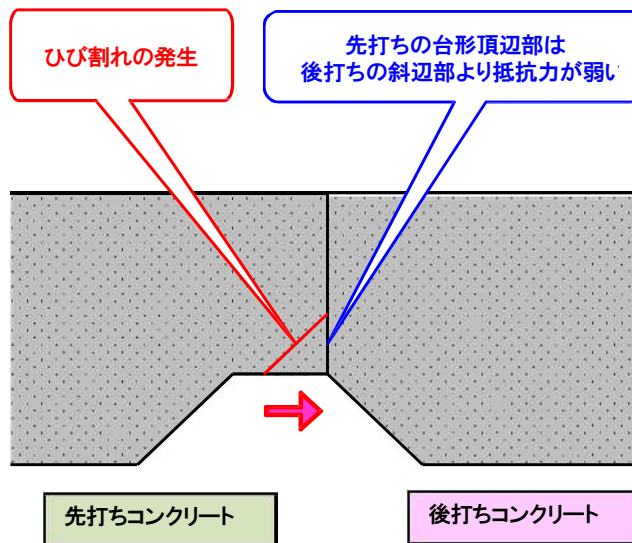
施工目地部が台形形状の場合のひび割れ発生
